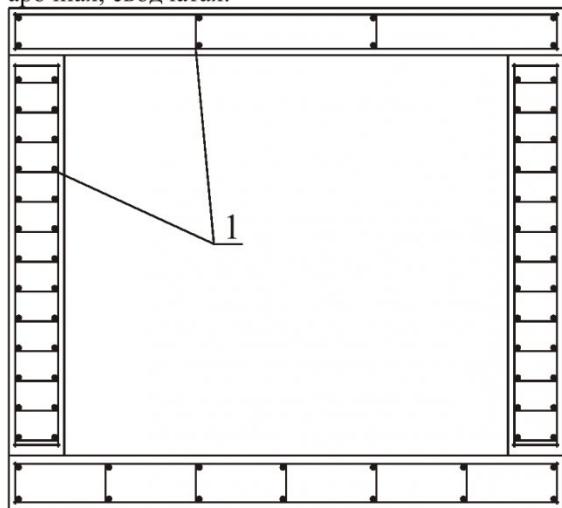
Конструкция крепи из сборного железобетона: 1 – арматурные сетки
